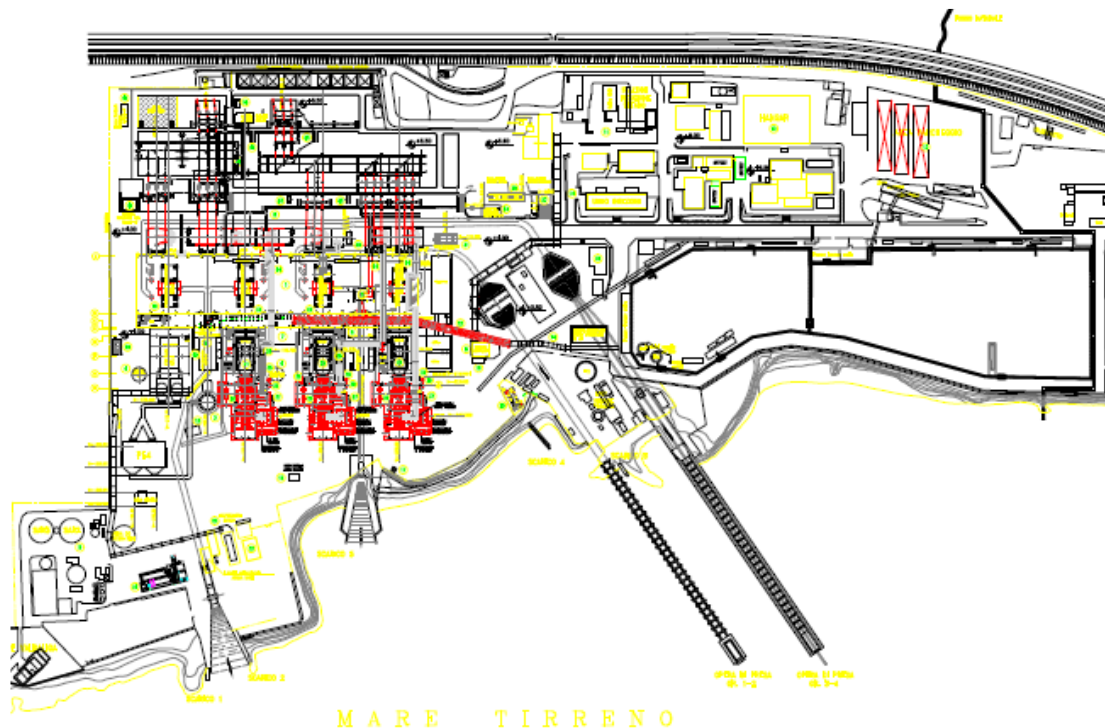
Planimetria generale – Stato attuale (Allegato n. 1)
